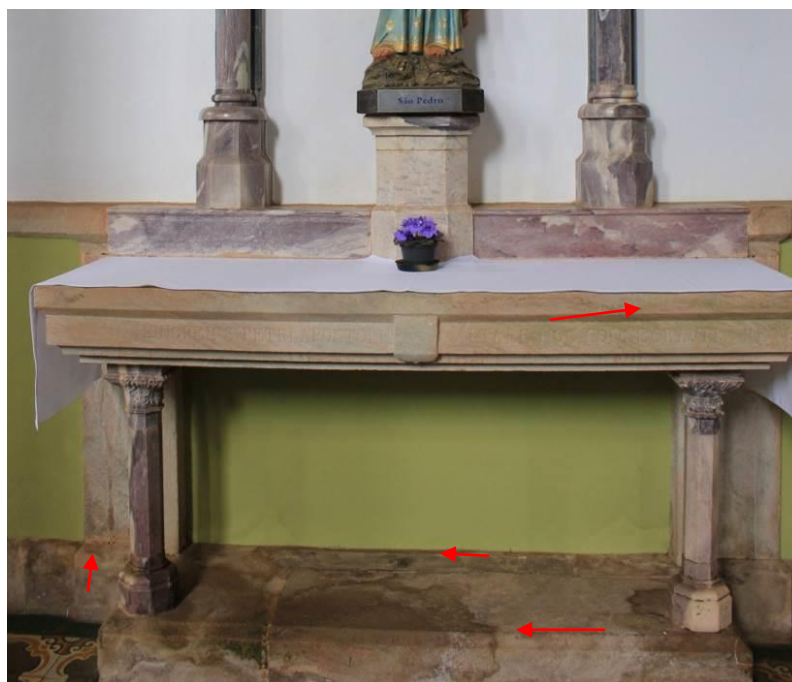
Detalhe da imagem de São Pedro fissura no suporte gerando instabilidade do atributo. Foto Maria Clara Assis.
